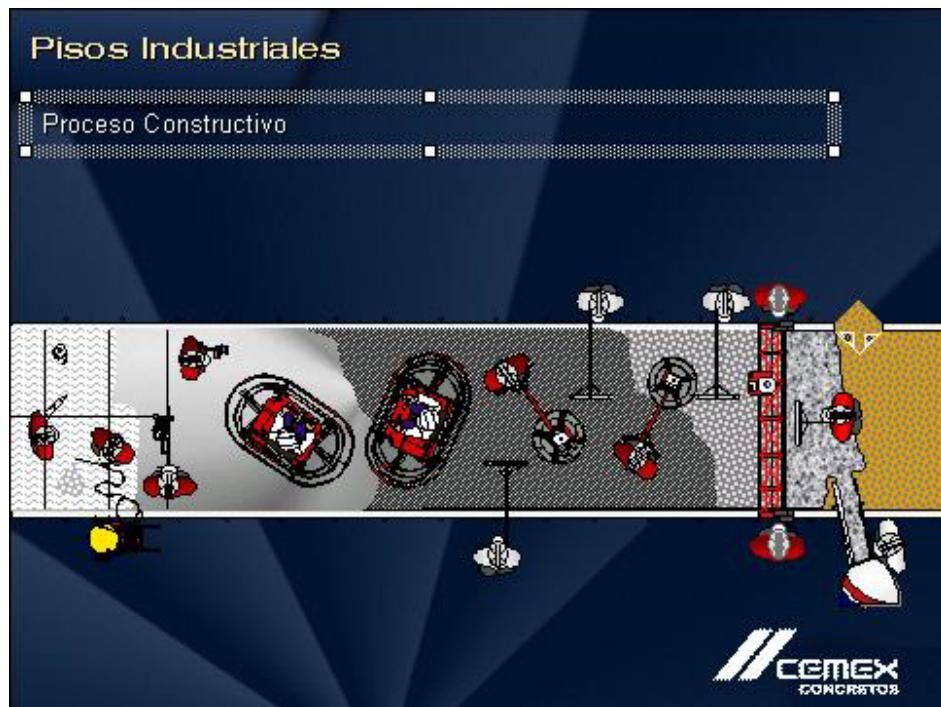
Proceso constructivo tipo para construcción de Pisos industriales
